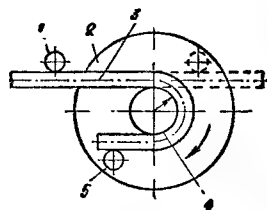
Схема изгиба арматурного стержня на механическом станке
